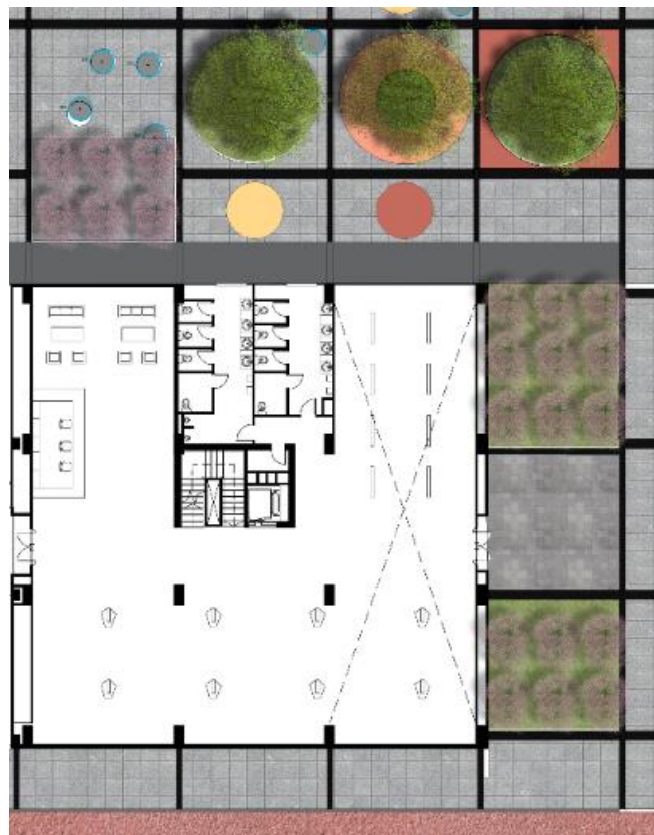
Planta baja de Torre. Fuente: Elaboración Propia
